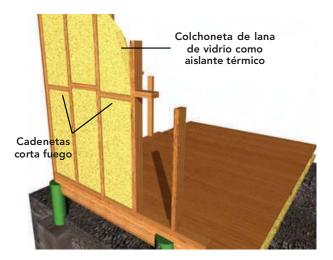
24: Tabique perimetral con aislante térmico tipo lana de vidrio.
